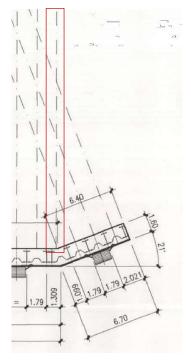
Posizione tirante numero 195 - 1114.STR.07.02 - Stato Attuale Planimetria e Sezioni\_Rev.2.
